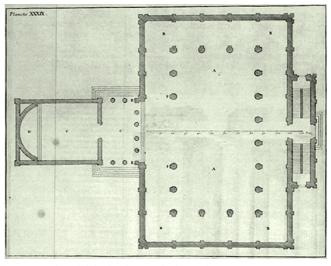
Planta de la basílica de Fano, Claude Perrault.
